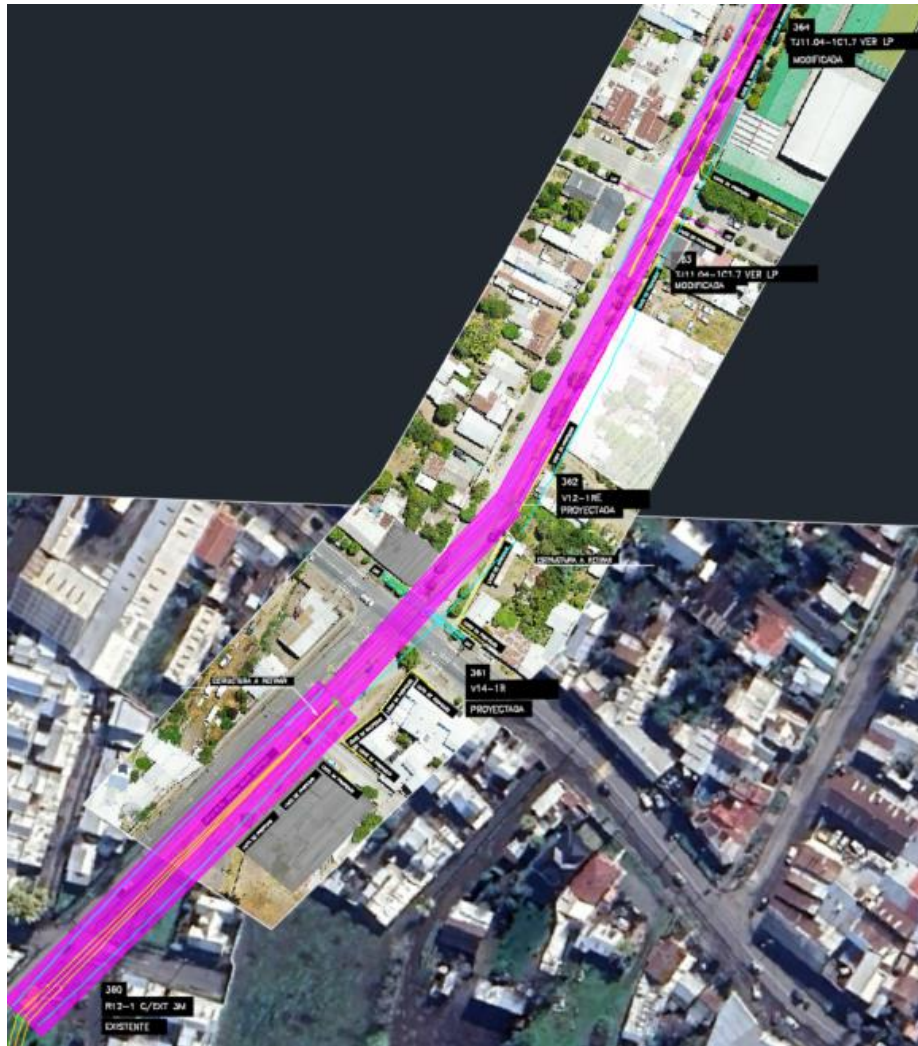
Tramo entre E360 – E367 (proyectado)
